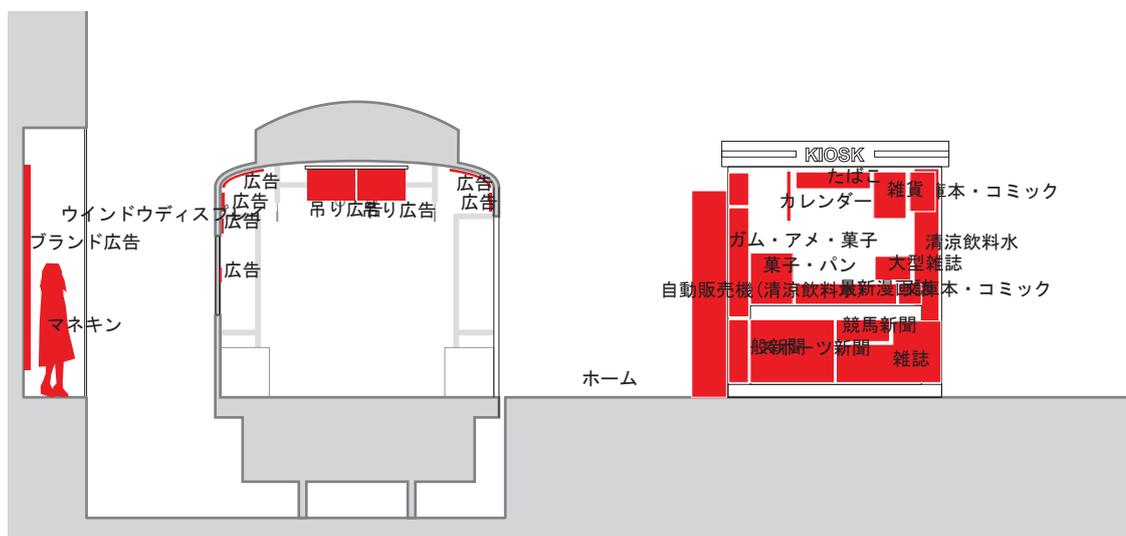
JR 荻窪駅構内断面図 1:100
